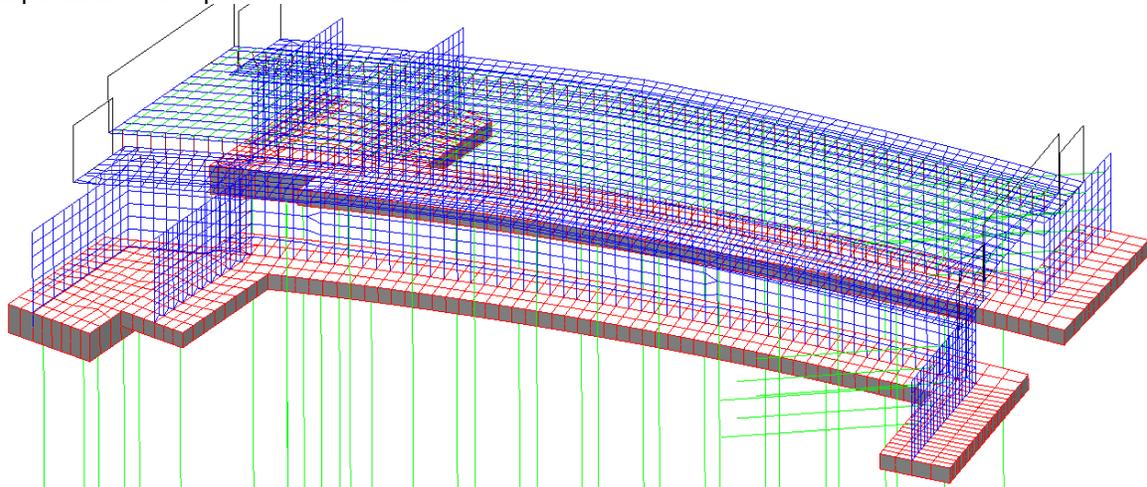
Modello 3D - Particolare delle fondazioni dei muri
